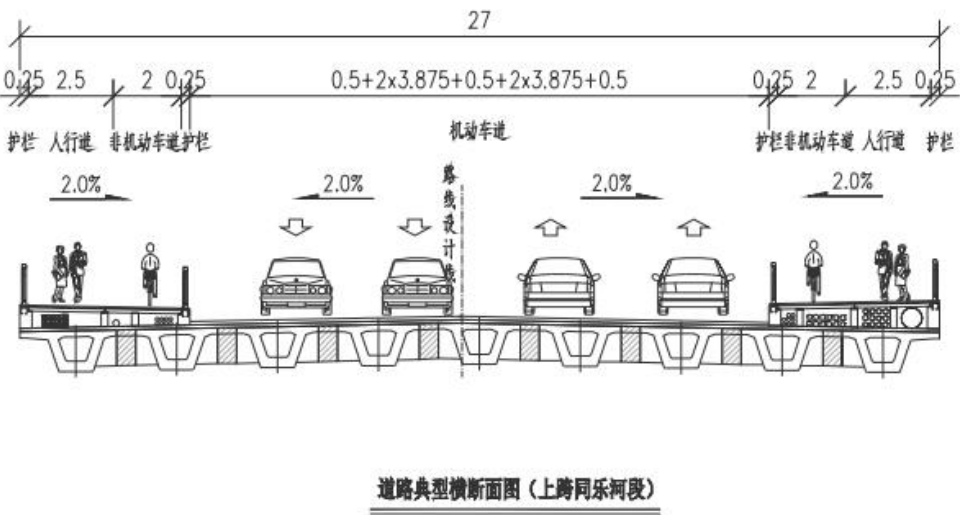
项目桥梁横断面布置图（上跨同乐河段）
